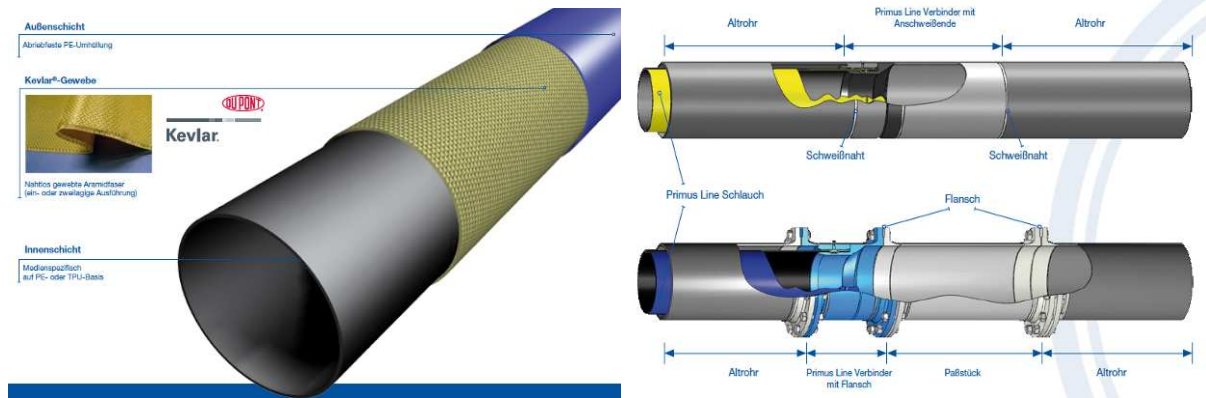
Aufbau des Primus Line Schlauch (links), Verbinder mit Flansch oder Anschweißende (rechts) [119]
